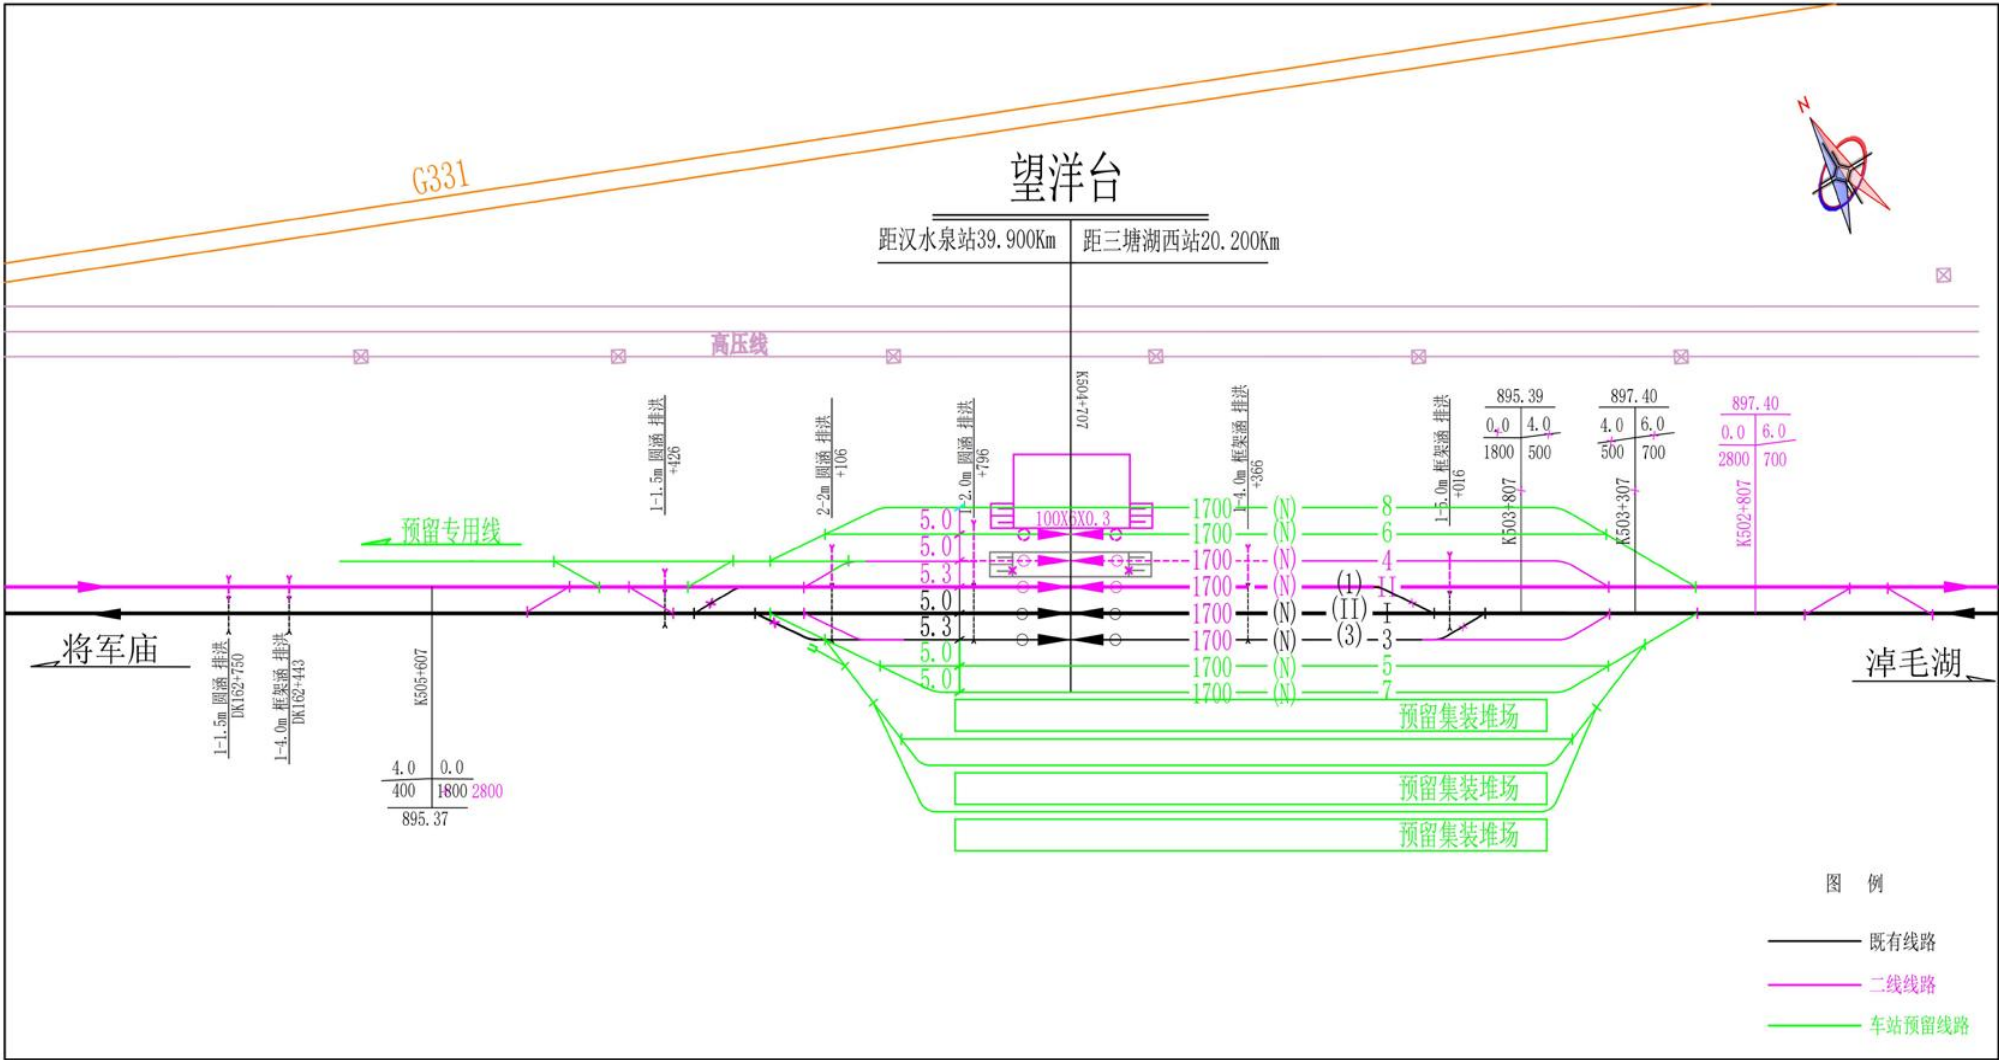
将淖铁路增建二线后望洋台站平面布置示意图
